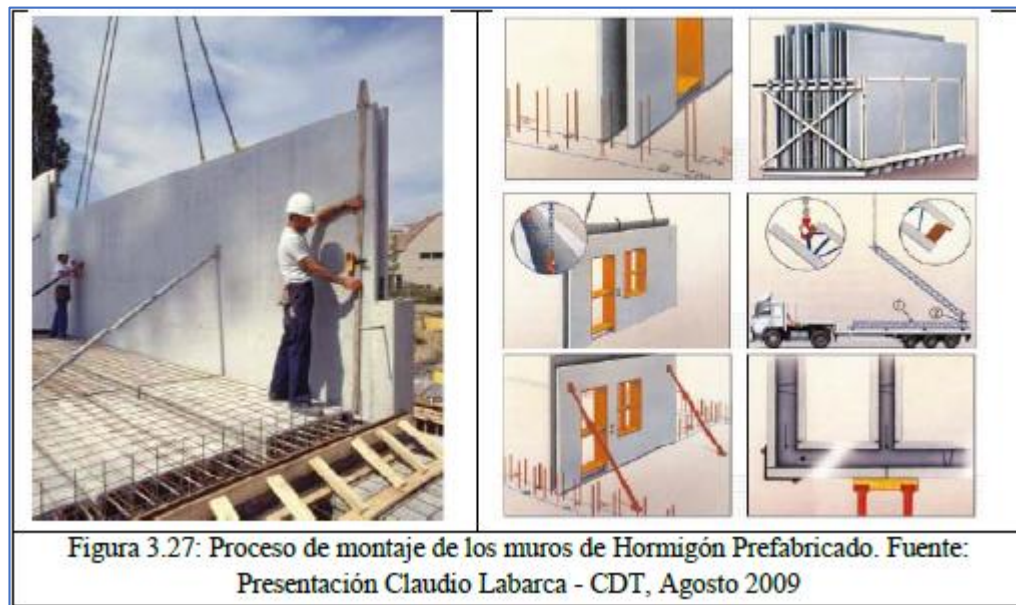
Proceso de montaje de los muros de hormigón Prefabricado
